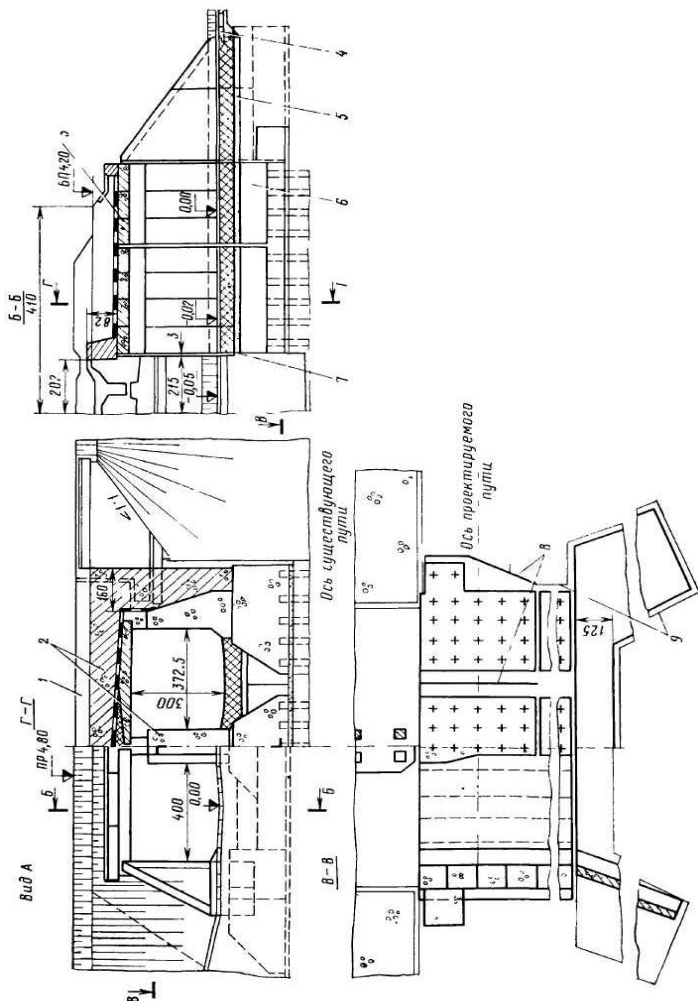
Пристройка нетиповой трубы (размеры в сантиметрах): 1 – существующий мост; 2 – переходное звено из монолитного бетона; 3 – сборная часть трубы; 4 – бетонные плиты укрепления русла; 5 – бетонный лоток; 6 – ростверк с деревянными сваями; 7 – разбираемые части фундаментов устоев и насадки промежуточной опоры; 8, 9 – шпунтовые ограждения из бруса и досок
